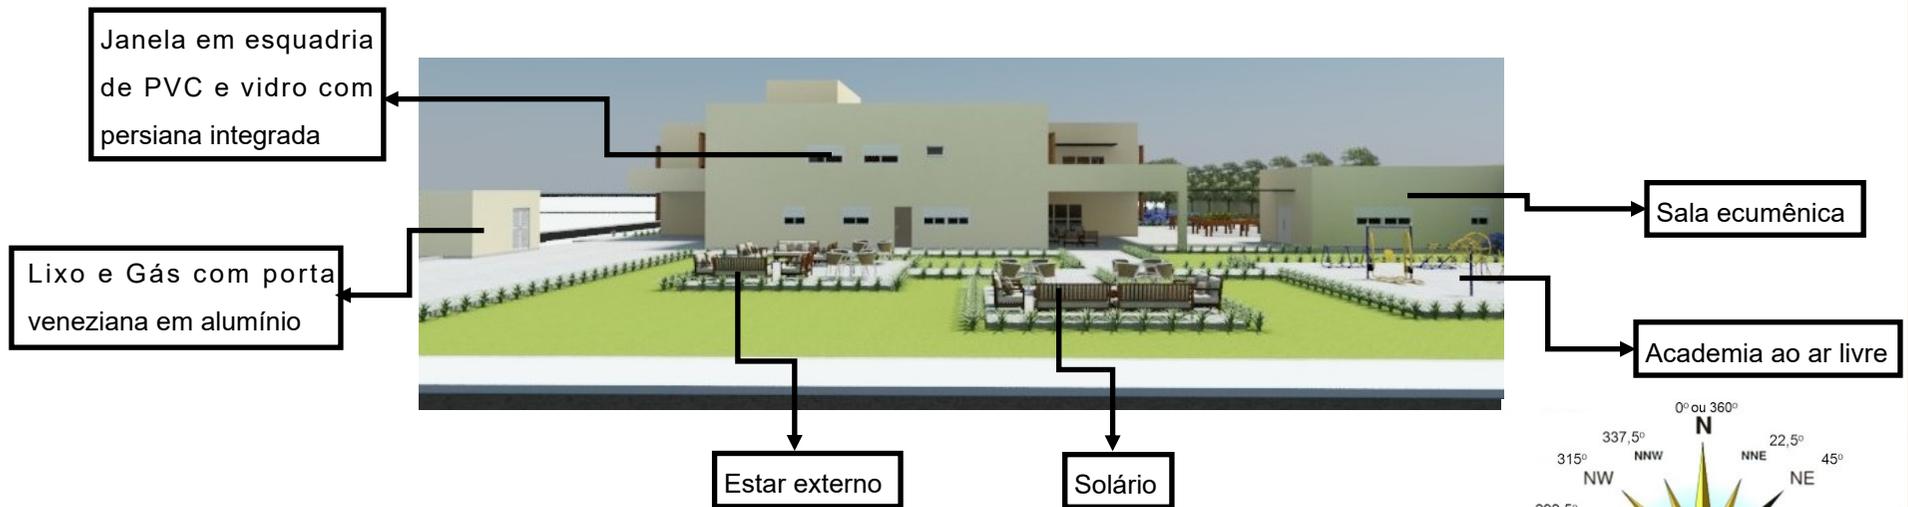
Fachada lés-nordeste (ENE – 67,5°), Rua Dr. Otto Feuerschuette
